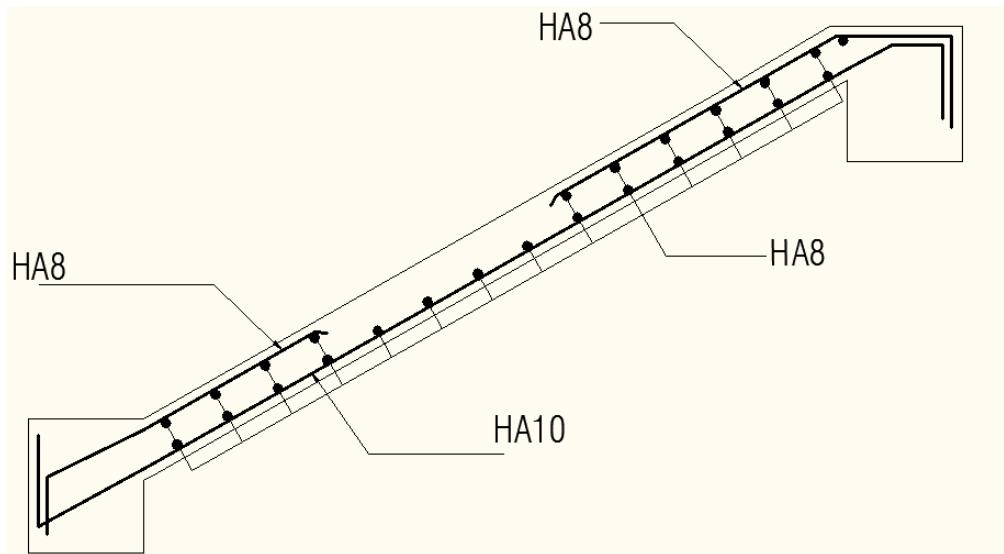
Schéma de ferrailage de l'escalier type 1
